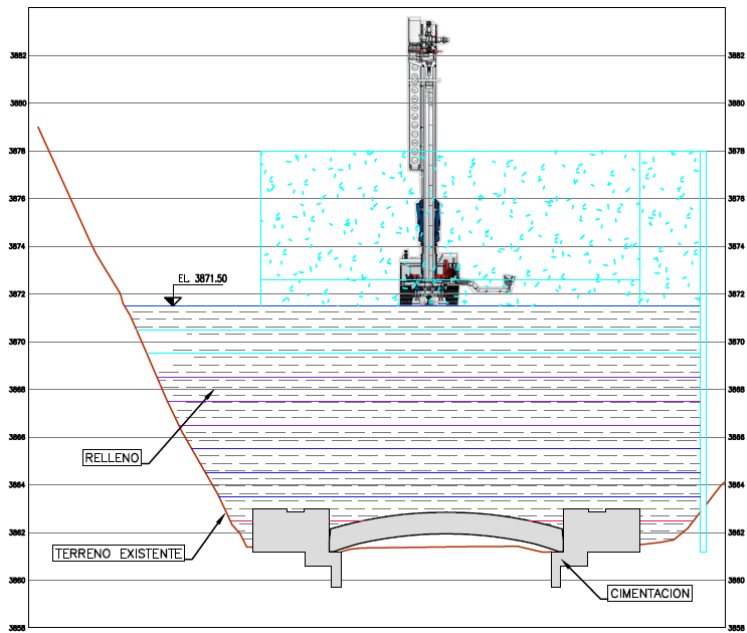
Vista em corte da plataforma em betão armado com perfuradora em operações.
